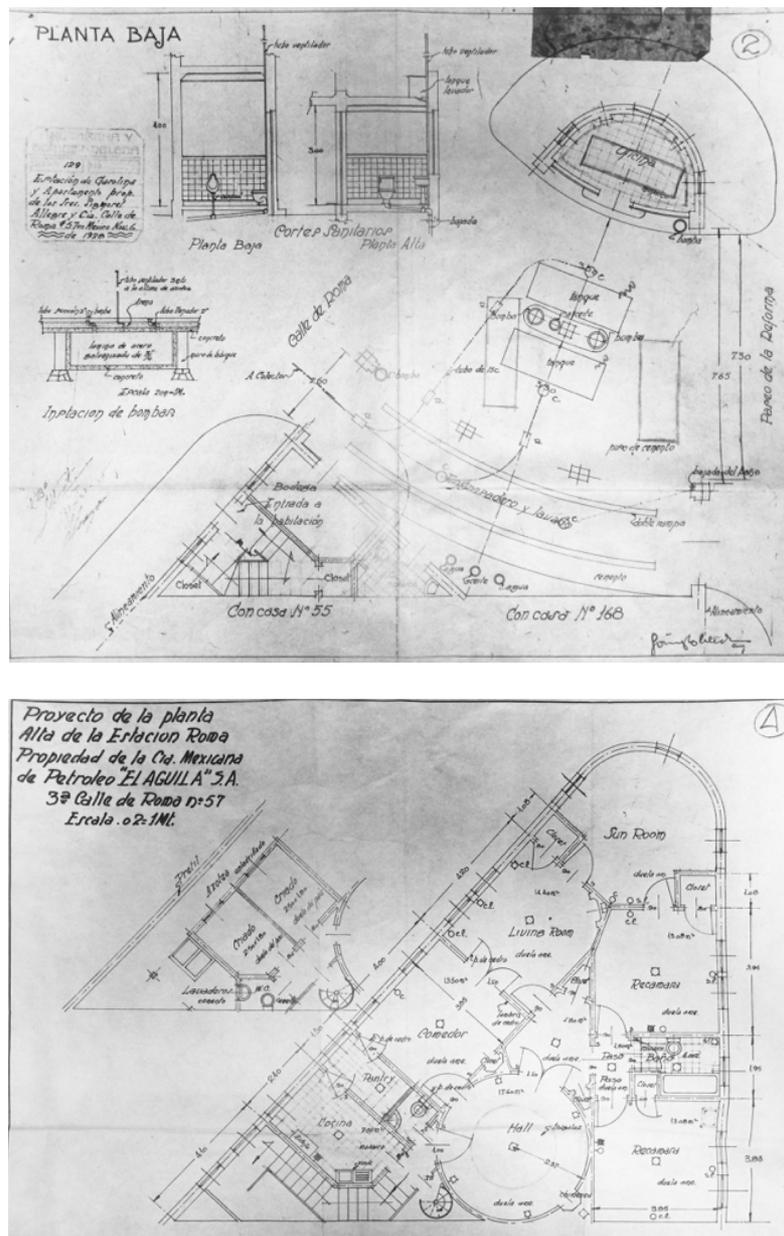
Proyecto para la Estación Roma, con expendio de gasolina en planta baja y departamento en planta alta. Archivo Histórico Pemex. Fondo: Expropiación. Caja 4068, Exp. 98295, f. 81. 1928.
